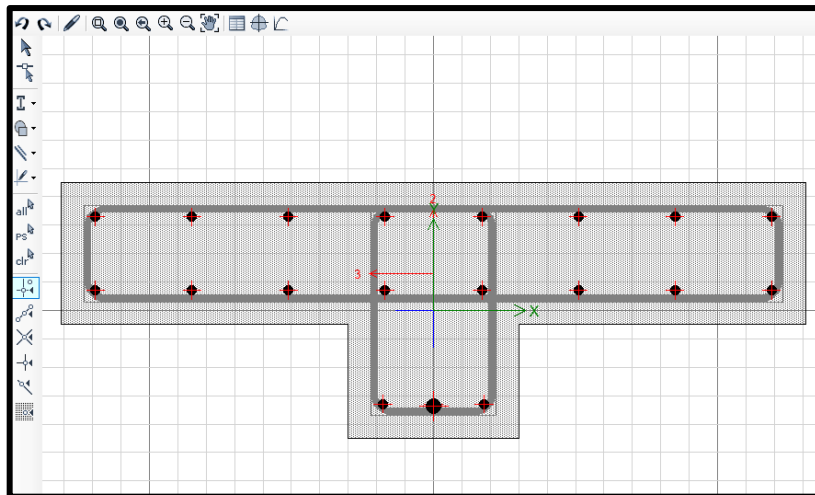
Características del Elemento Estructural Columna en Section Designer.
